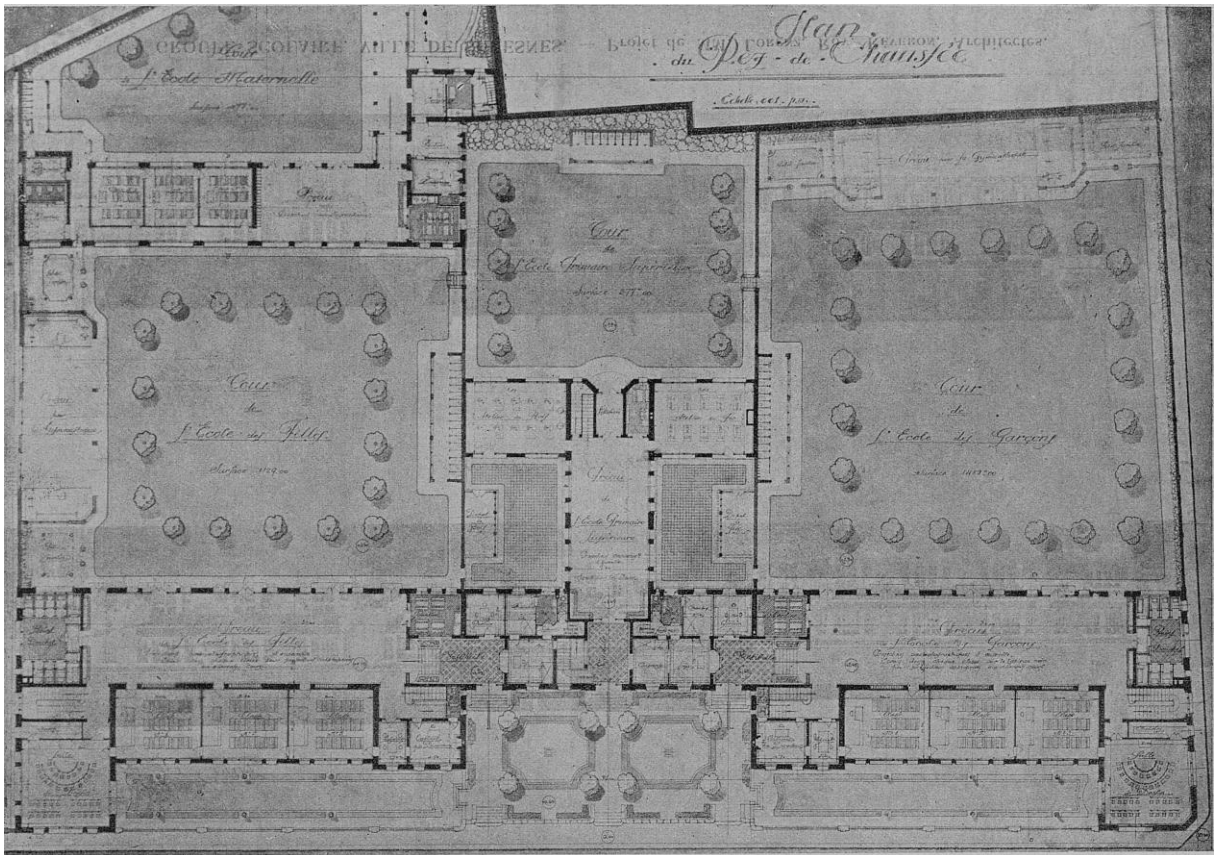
Groupe scolaire de la ville de Suresnes. Projet de Lorenz et Roy. Plan du rez-de-chaussée. *La Construction Moderne*, 7 aout 1921, 36<sup>ème</sup> année, n°45, pl. 178.
